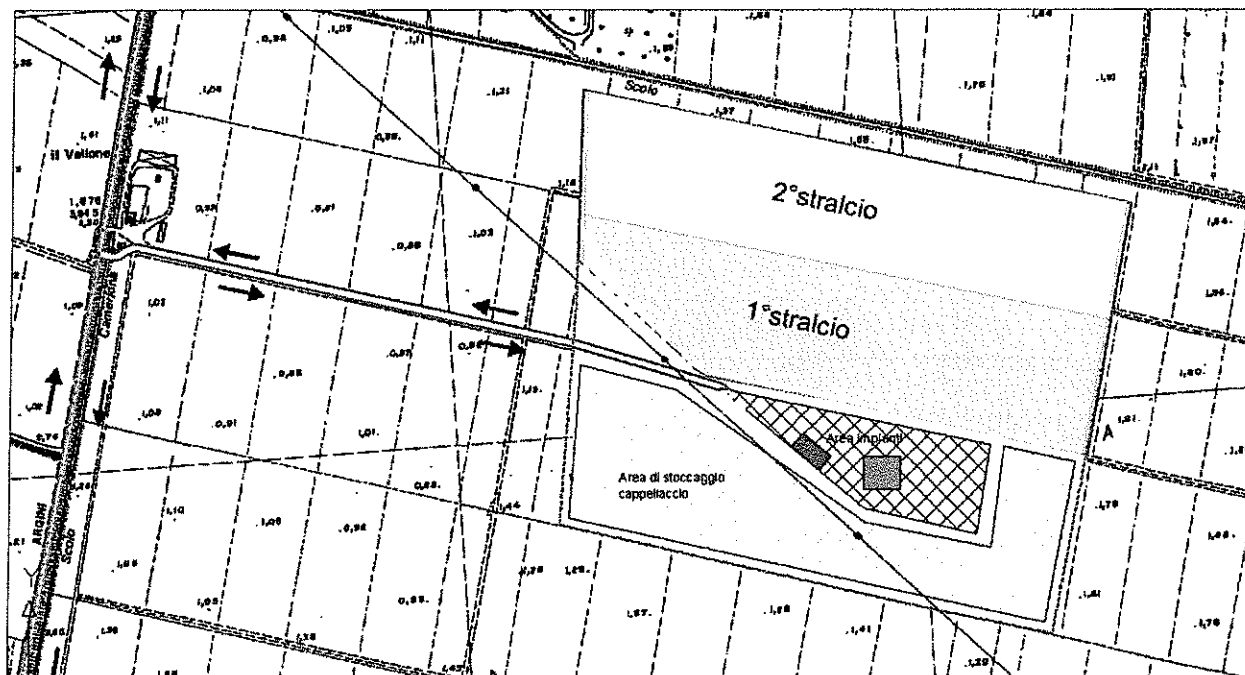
Predisposizione dell'area per il piano di coltivazione
